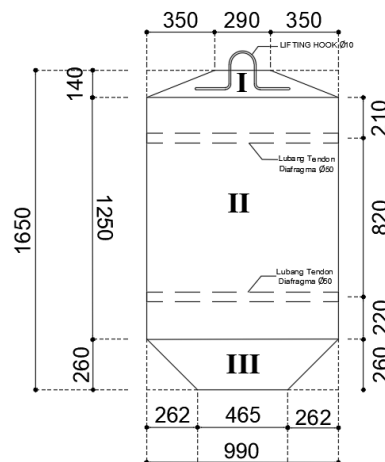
Potongan Melintang PCI Girder Bangun 2
